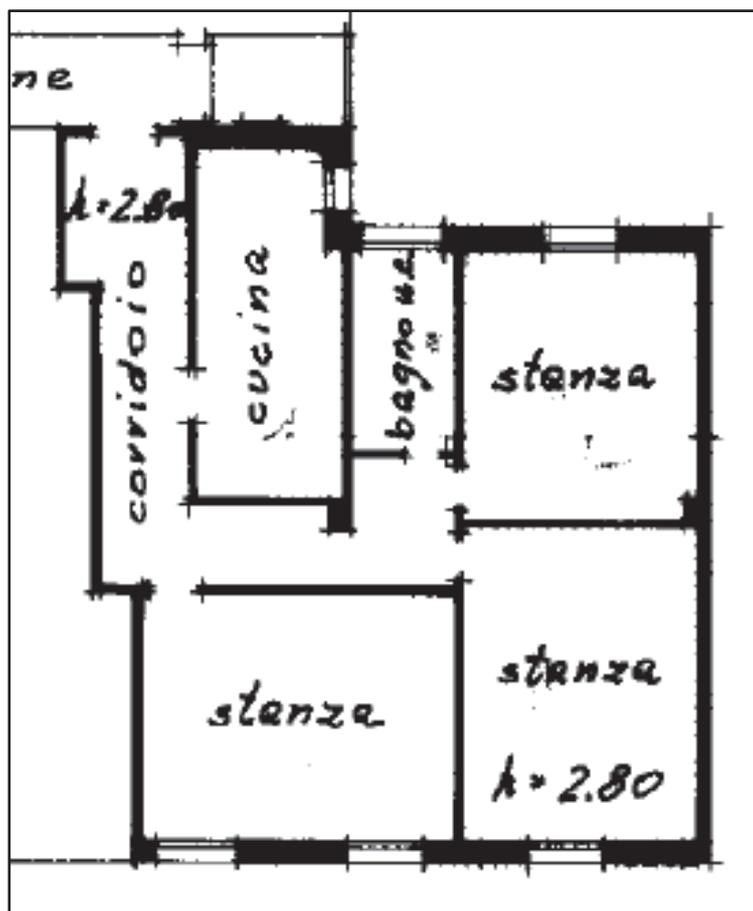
Pianta dell'appartamento tratta dalla scheda planimetrica catastale
